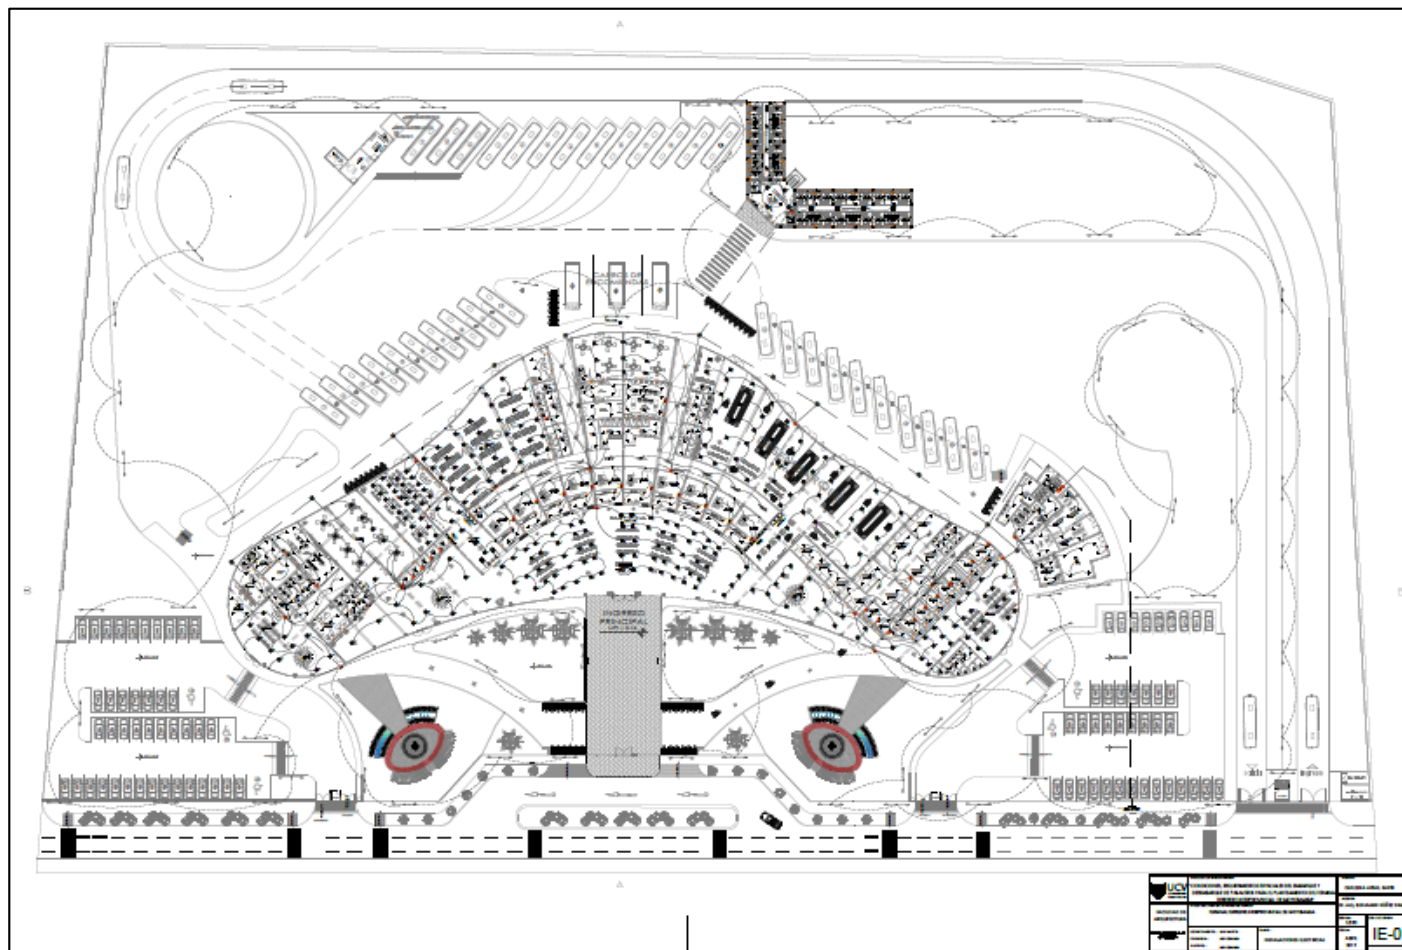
Plano instalaciones eléctricas, Fuente: Elaboración propia.
